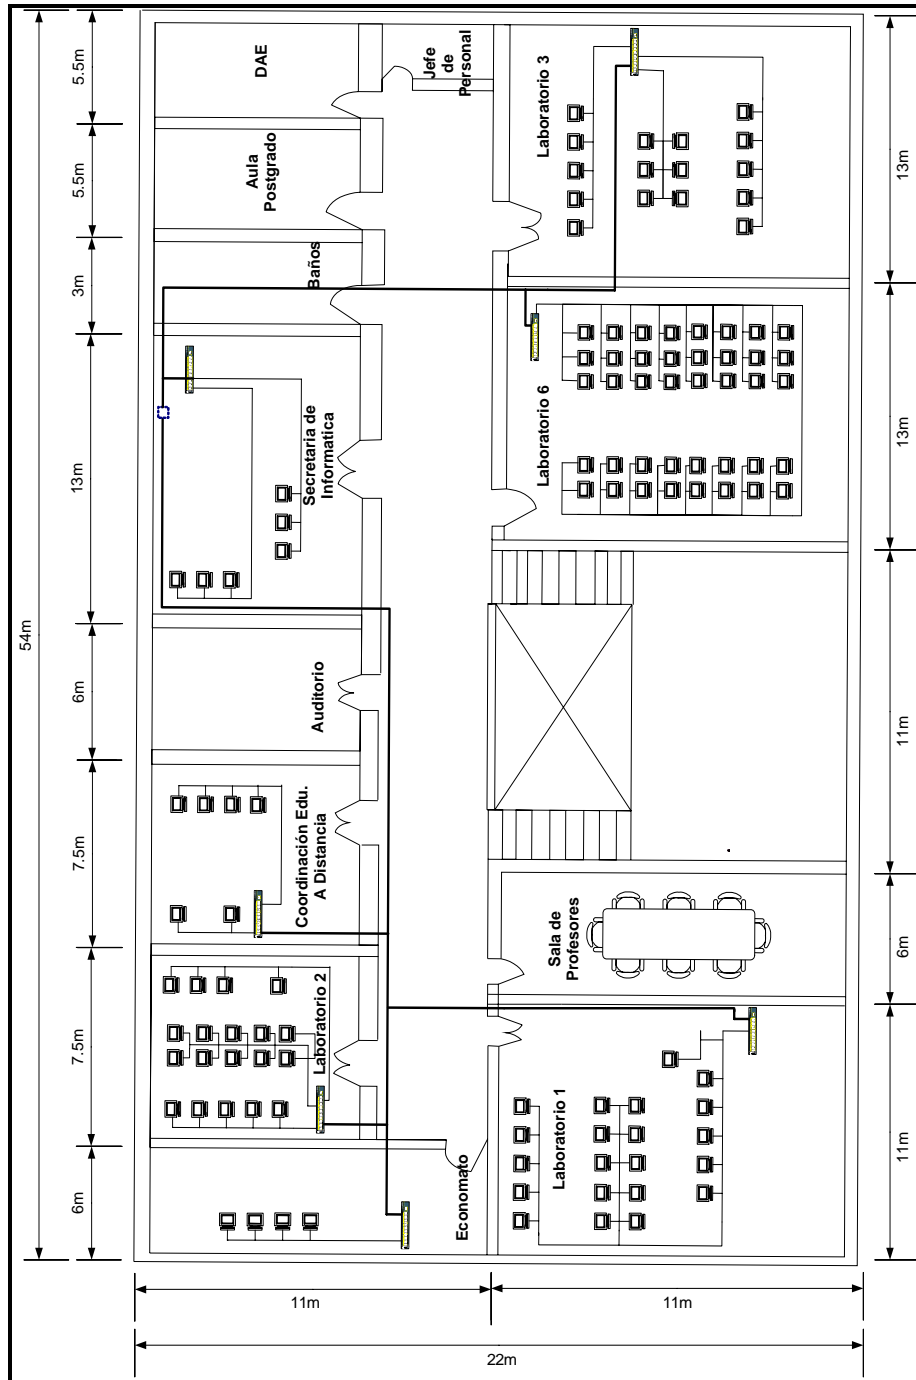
Plano Digital Primer Piso – Edificio Principal
